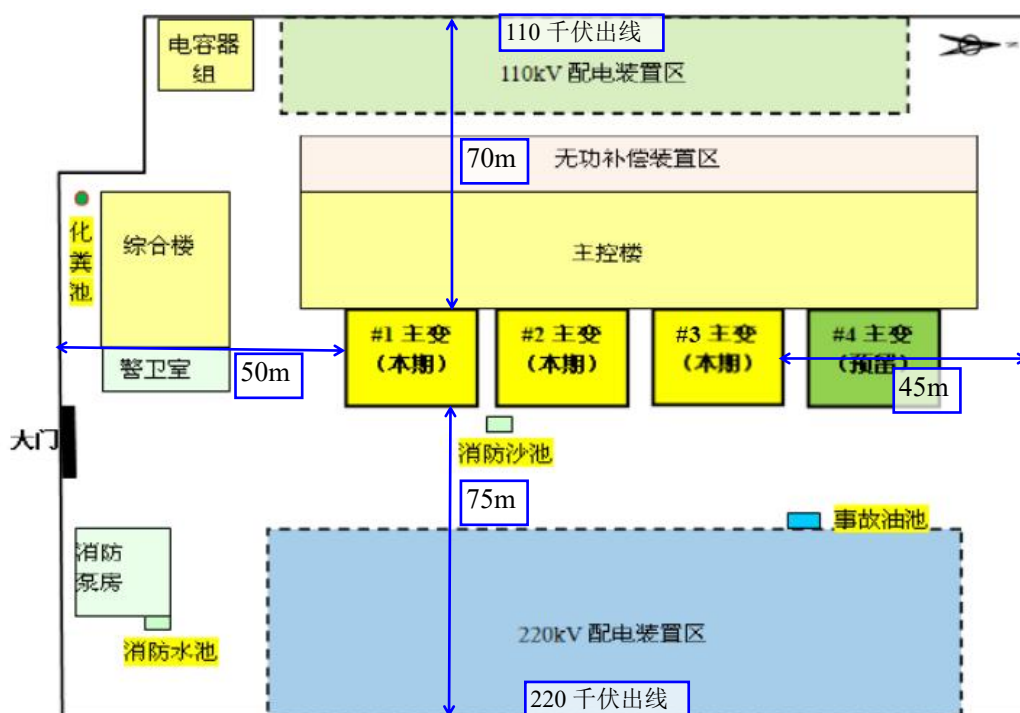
220kV 荣田变电站总平面布置示意图（监测时）
